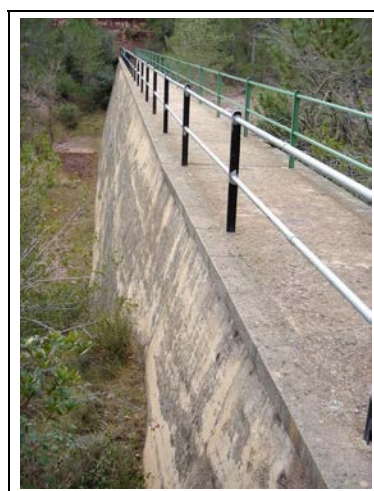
Resclosa secundària al sector de la Mola Trucada.
